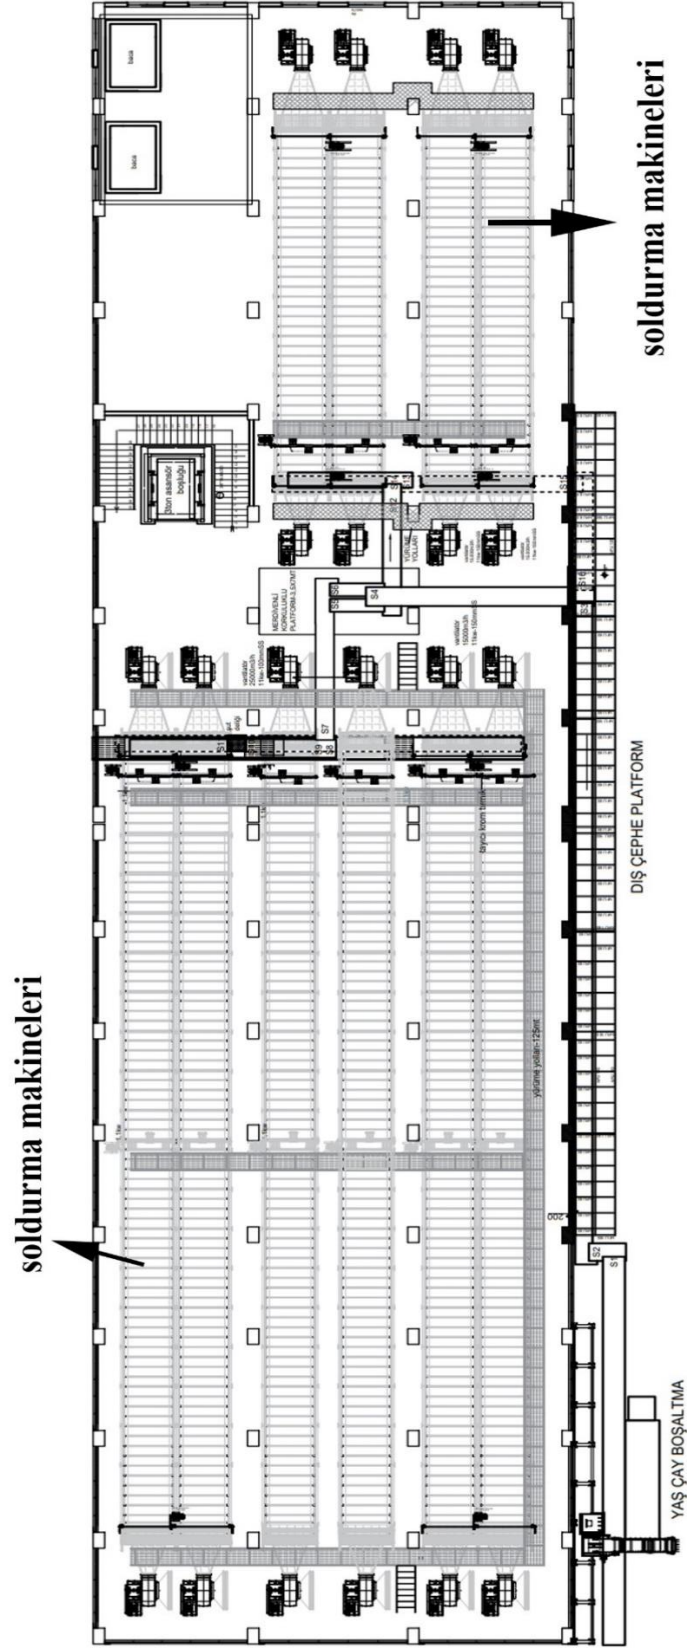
Vaziyet planı (Çaykur Organik İkizdere Çay Fabrikası).
